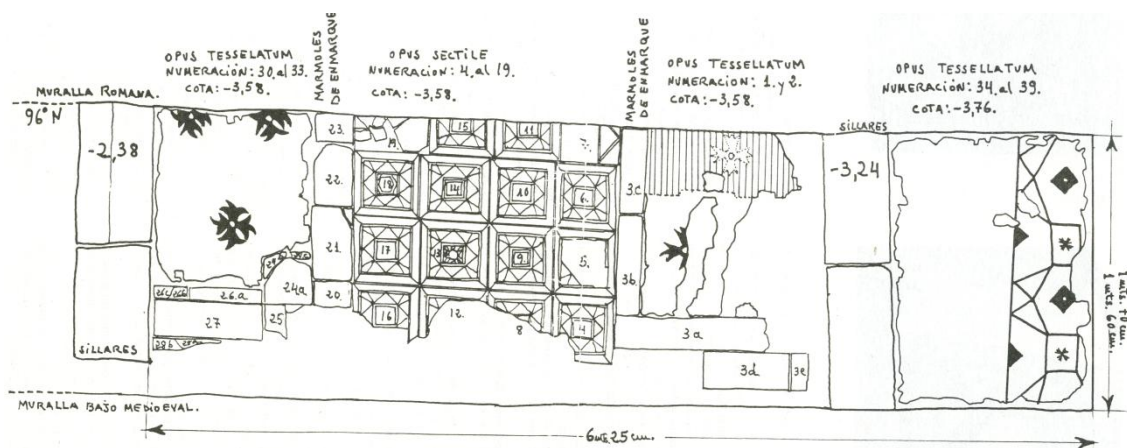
Pl. de Colón 5: planta de las estructuras domésticas localizadas (COSTA, 1992, fig. 1).
